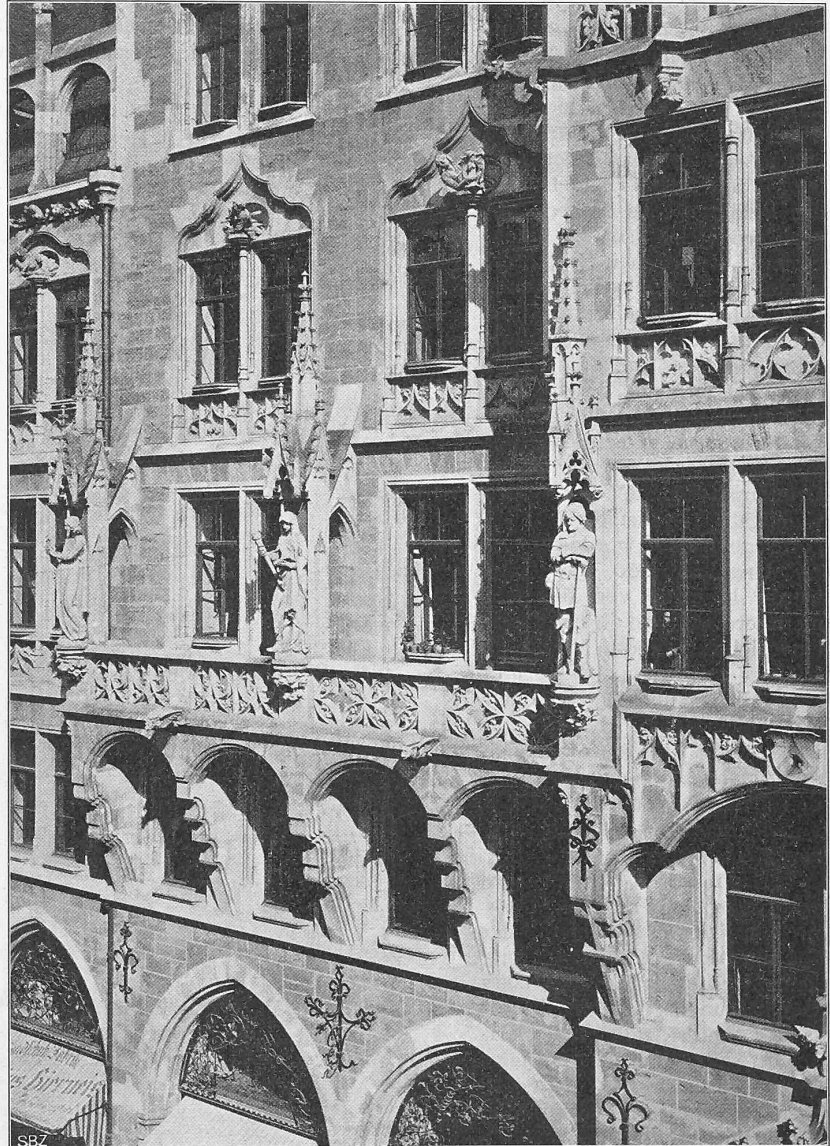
Ausschnitt aus dem Mittelteil der Weinstrassen-Fassade.
